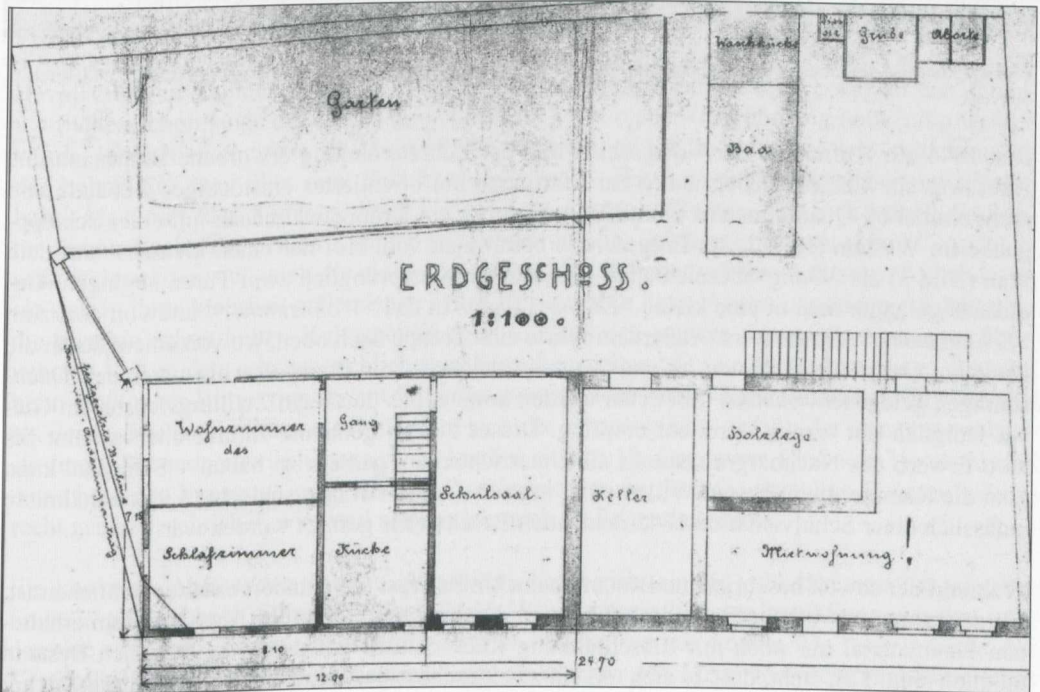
Lageplan und Grundriss des Erdgeschosses. Planzeichnung des Bezirksbaumeisters Häußler, 1908 (Pfälzisches Landesarchiv, Speyer)
